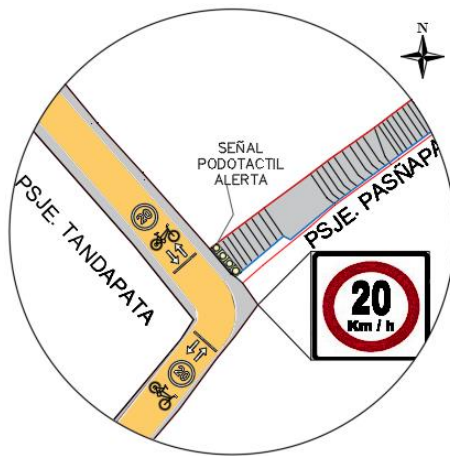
Pavimento táctil de alerta en la calle Tandapata con 7 Angelitos
